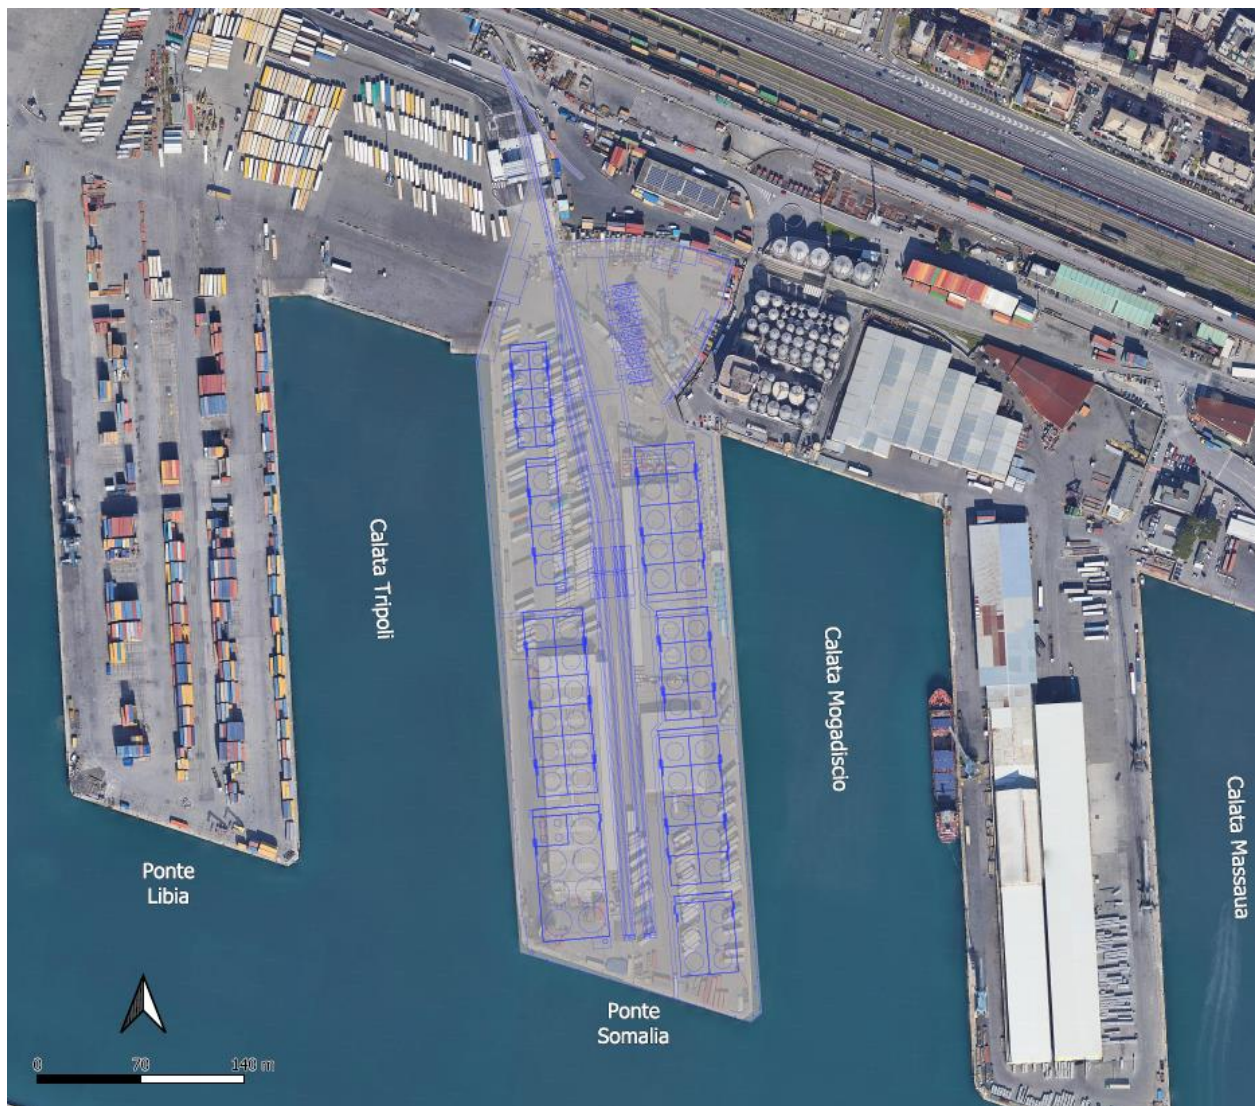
Planimetria generale del progetto proposto (Tavola 2)
